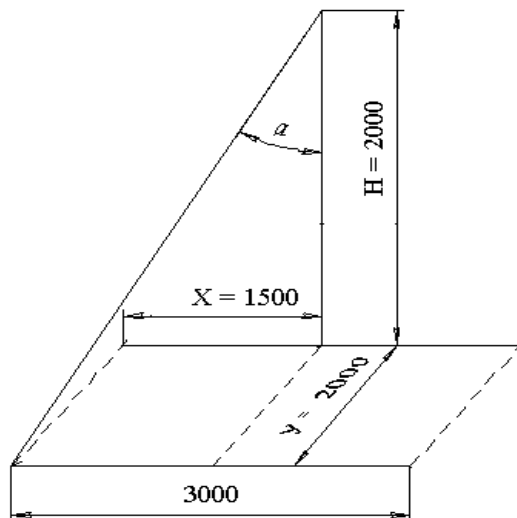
Взаимное расположение источника света и контрольной точки (к расчету площадки перед входом)
